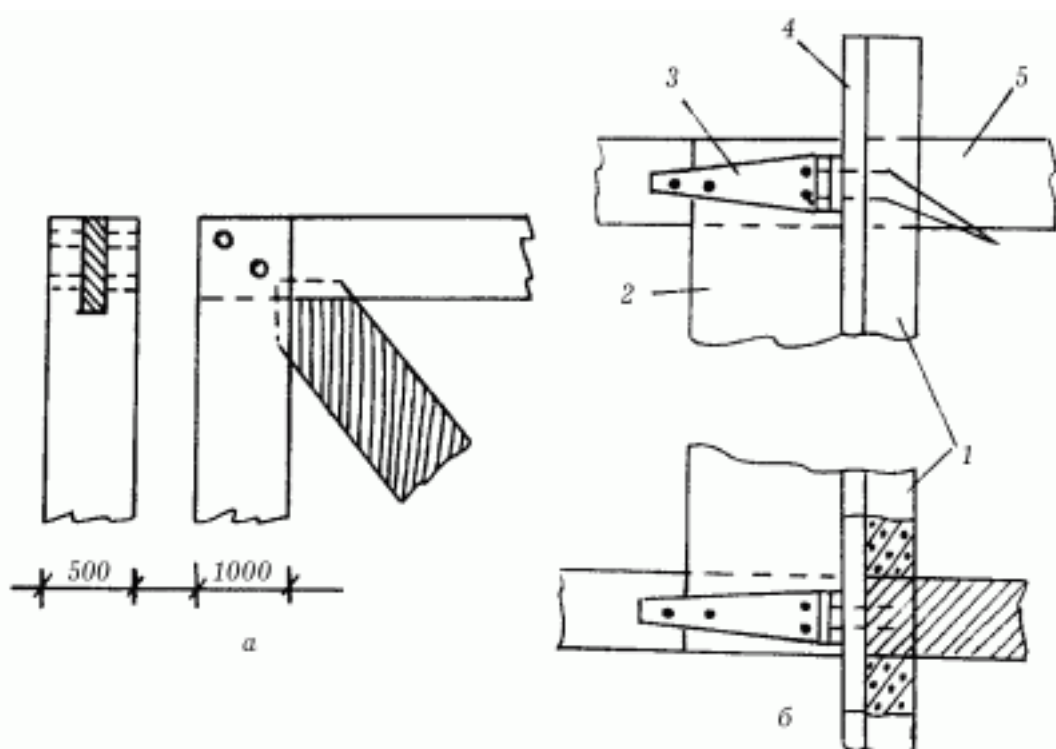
Угловое соединение рамы деревянных ворот (а) и их навеска на железобетонные столбы (б): 1 – железобетонный столб; 2 – рама створки; 3 – амбарная петля; 4 – накладка; 5 – слега; 6 – гвозди.
